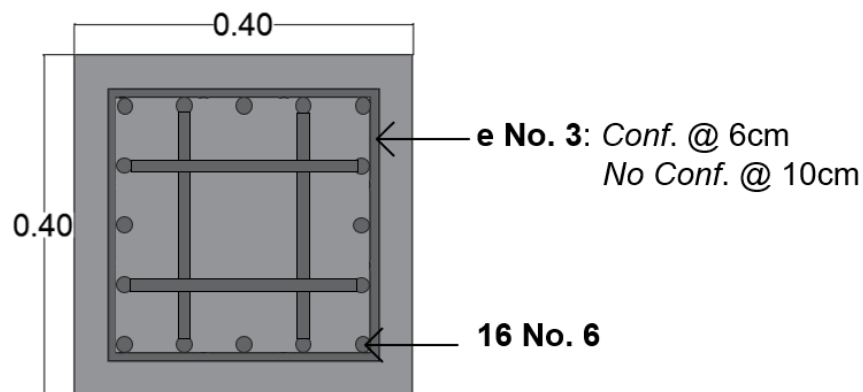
Sección transversal tipo para las columnas en concreto reforzado de la propuesta estructural inicial.
